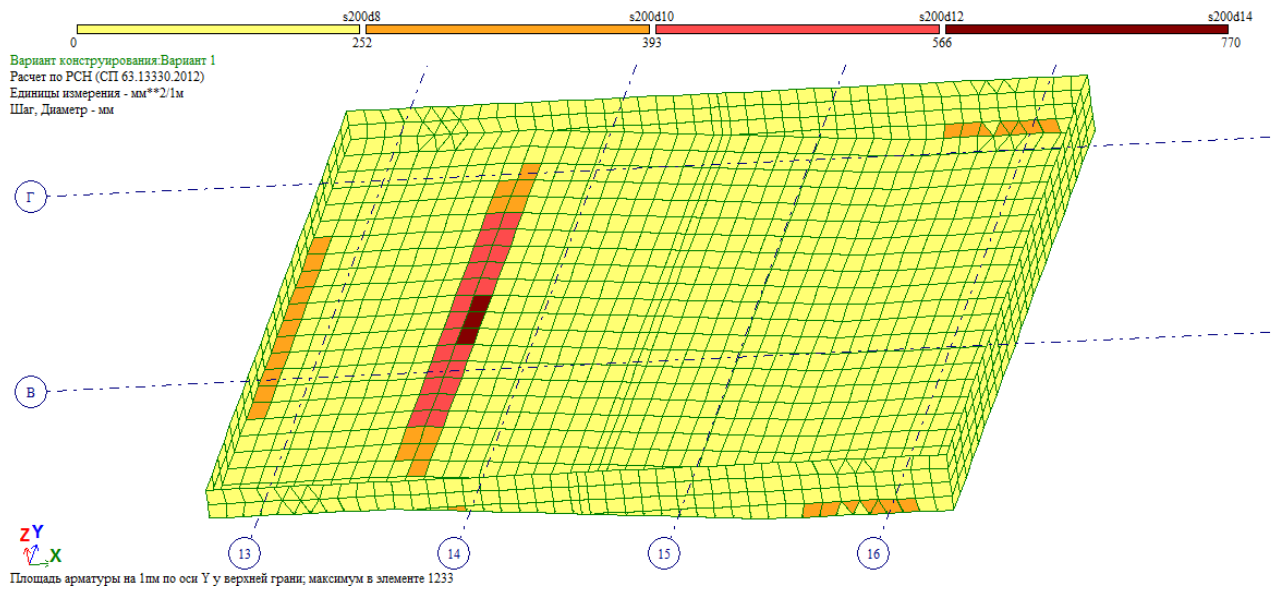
Продольная арматура верхней зоны вдоль цифровых осей
